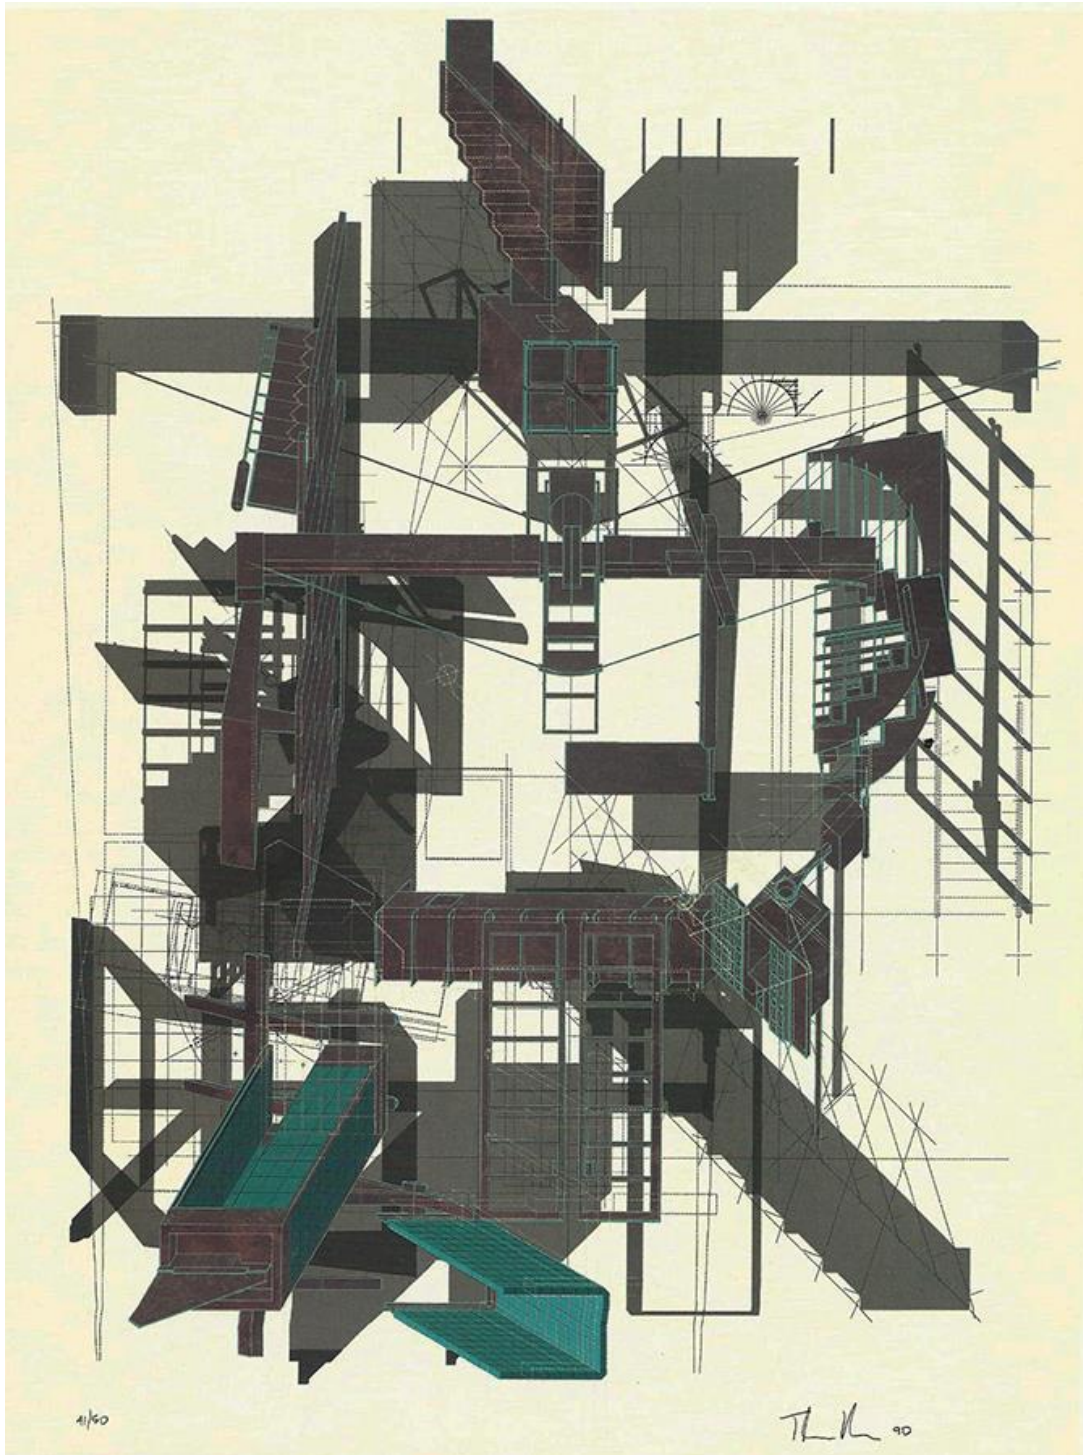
ภาพ axonometric plan โครงการ 6th Street House โดย Thom Mayne (1987)
